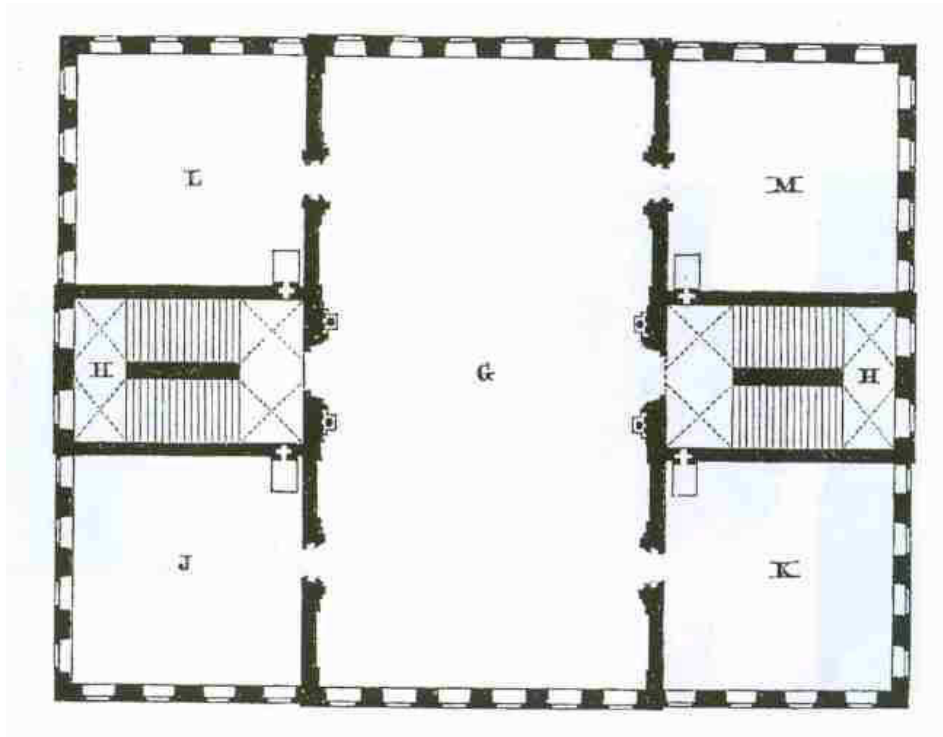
b: Grundriss Hauptgeschoss
